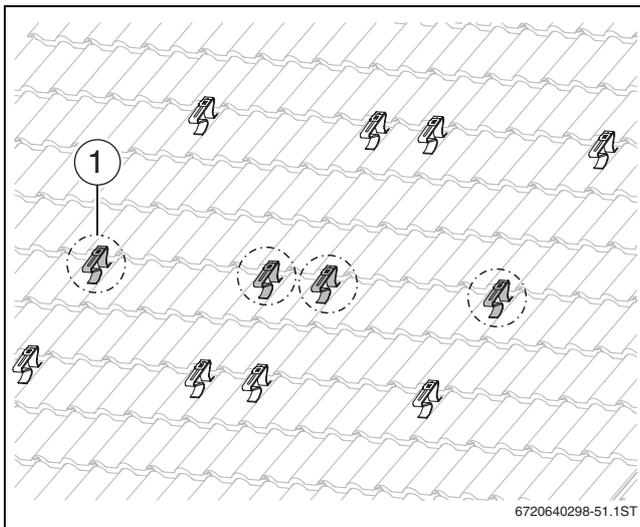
Ganchos de fixação adicionais para dois colectores juntos
